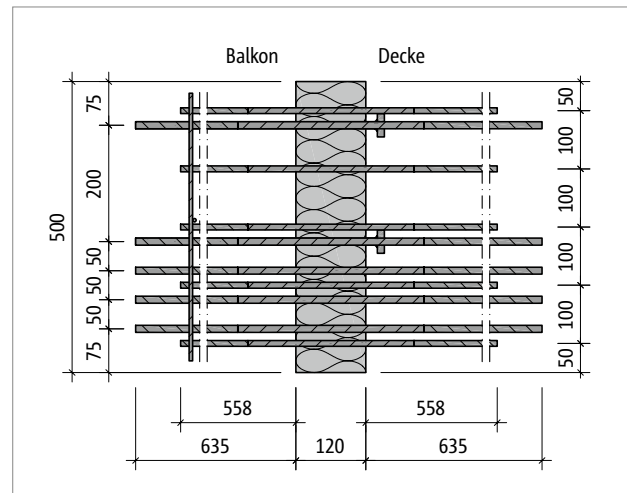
Schöck Isokorb® XT Typ CL-R-M1-V1: Produktgrundriss
